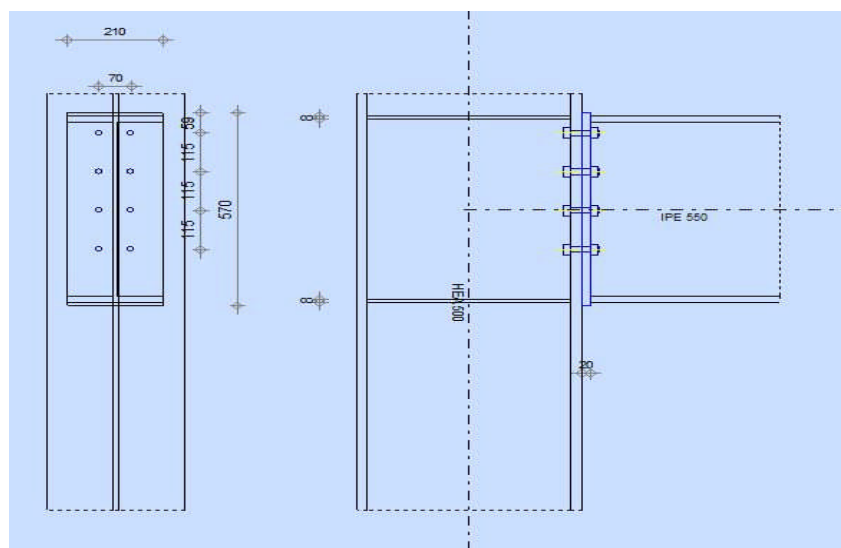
Vue de l'assemblage poteau – poutre maitresse.
